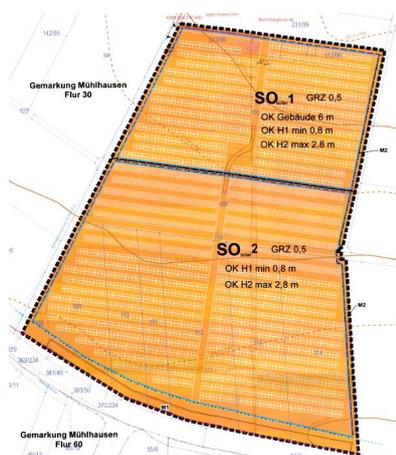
VEP-34 2Großsolarthermieanlage Auf dem Schadeberg“ – Planzeichnung (die aktuell gültige Planung)
